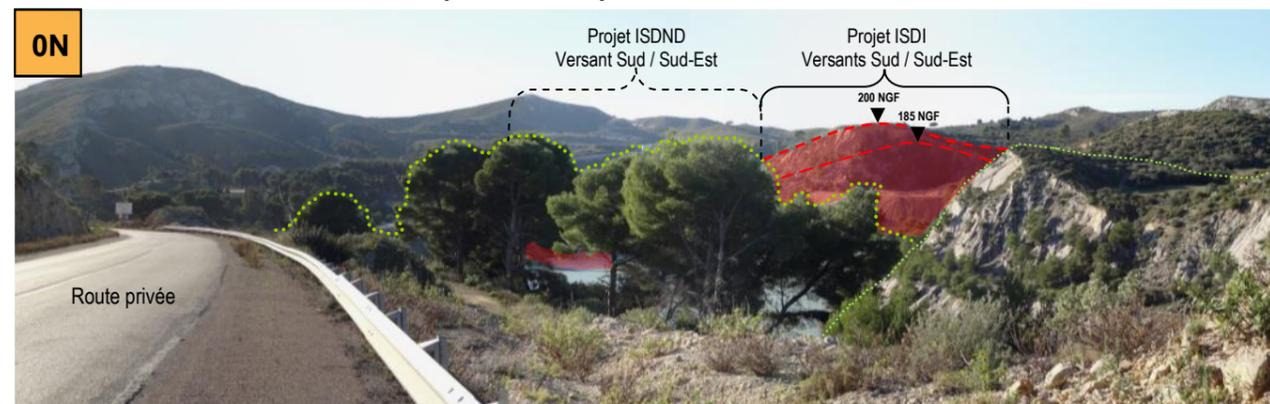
Vue depuis la route privée LAFARGE - Est de la carrière
